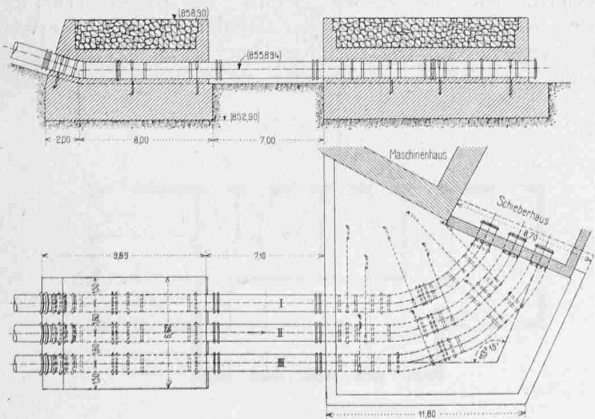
Grundriss und Längsschnitt. — Masstab 1 : 400.
